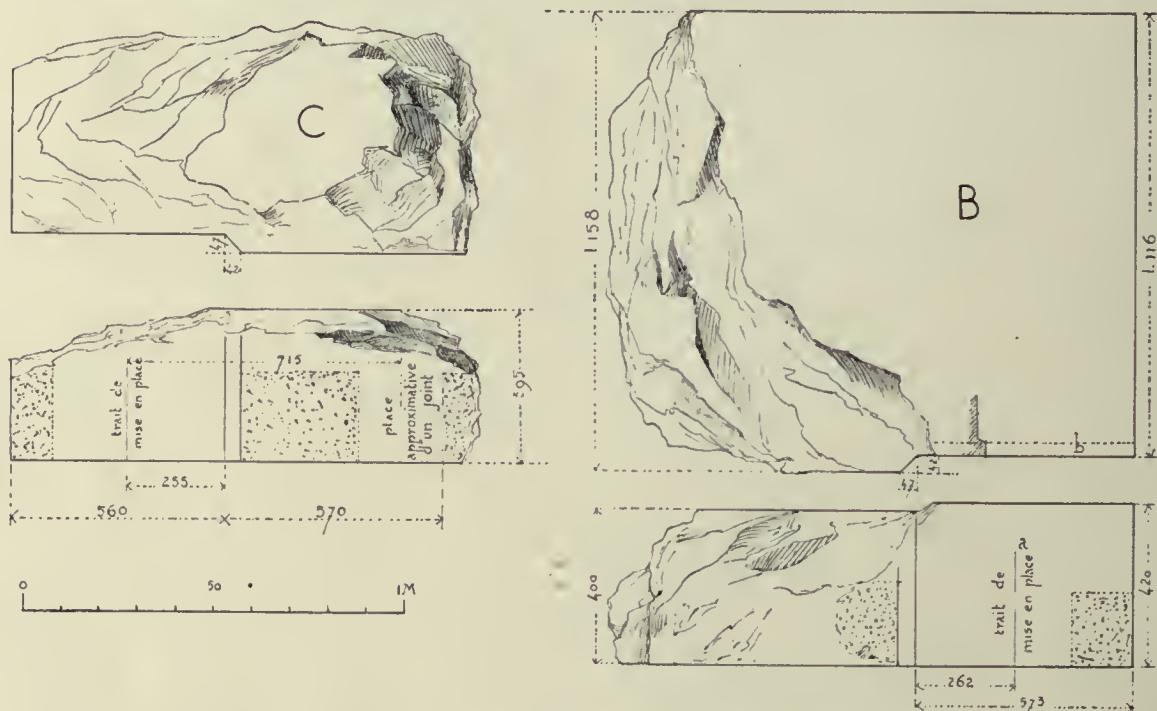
Dalles des péristyles latéraux, avec ressaut sur une des tranches.
